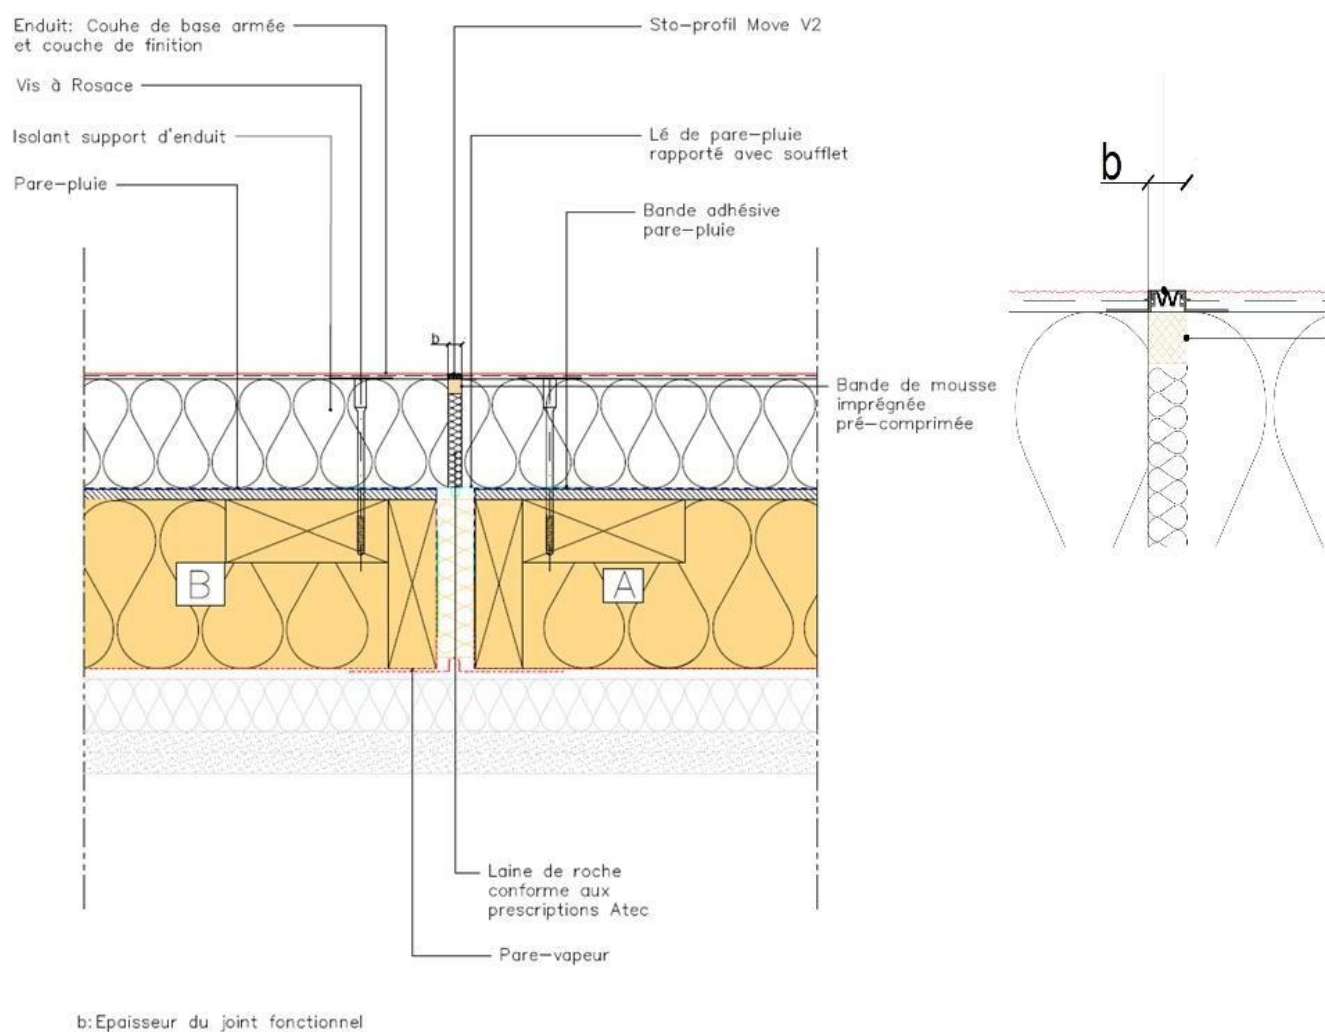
Jonction ETICS / ETICS dans un même plan entre 2 panneaux de FOB juxtaposés - Sto-Profil Move2 - Coupe Horizontale
